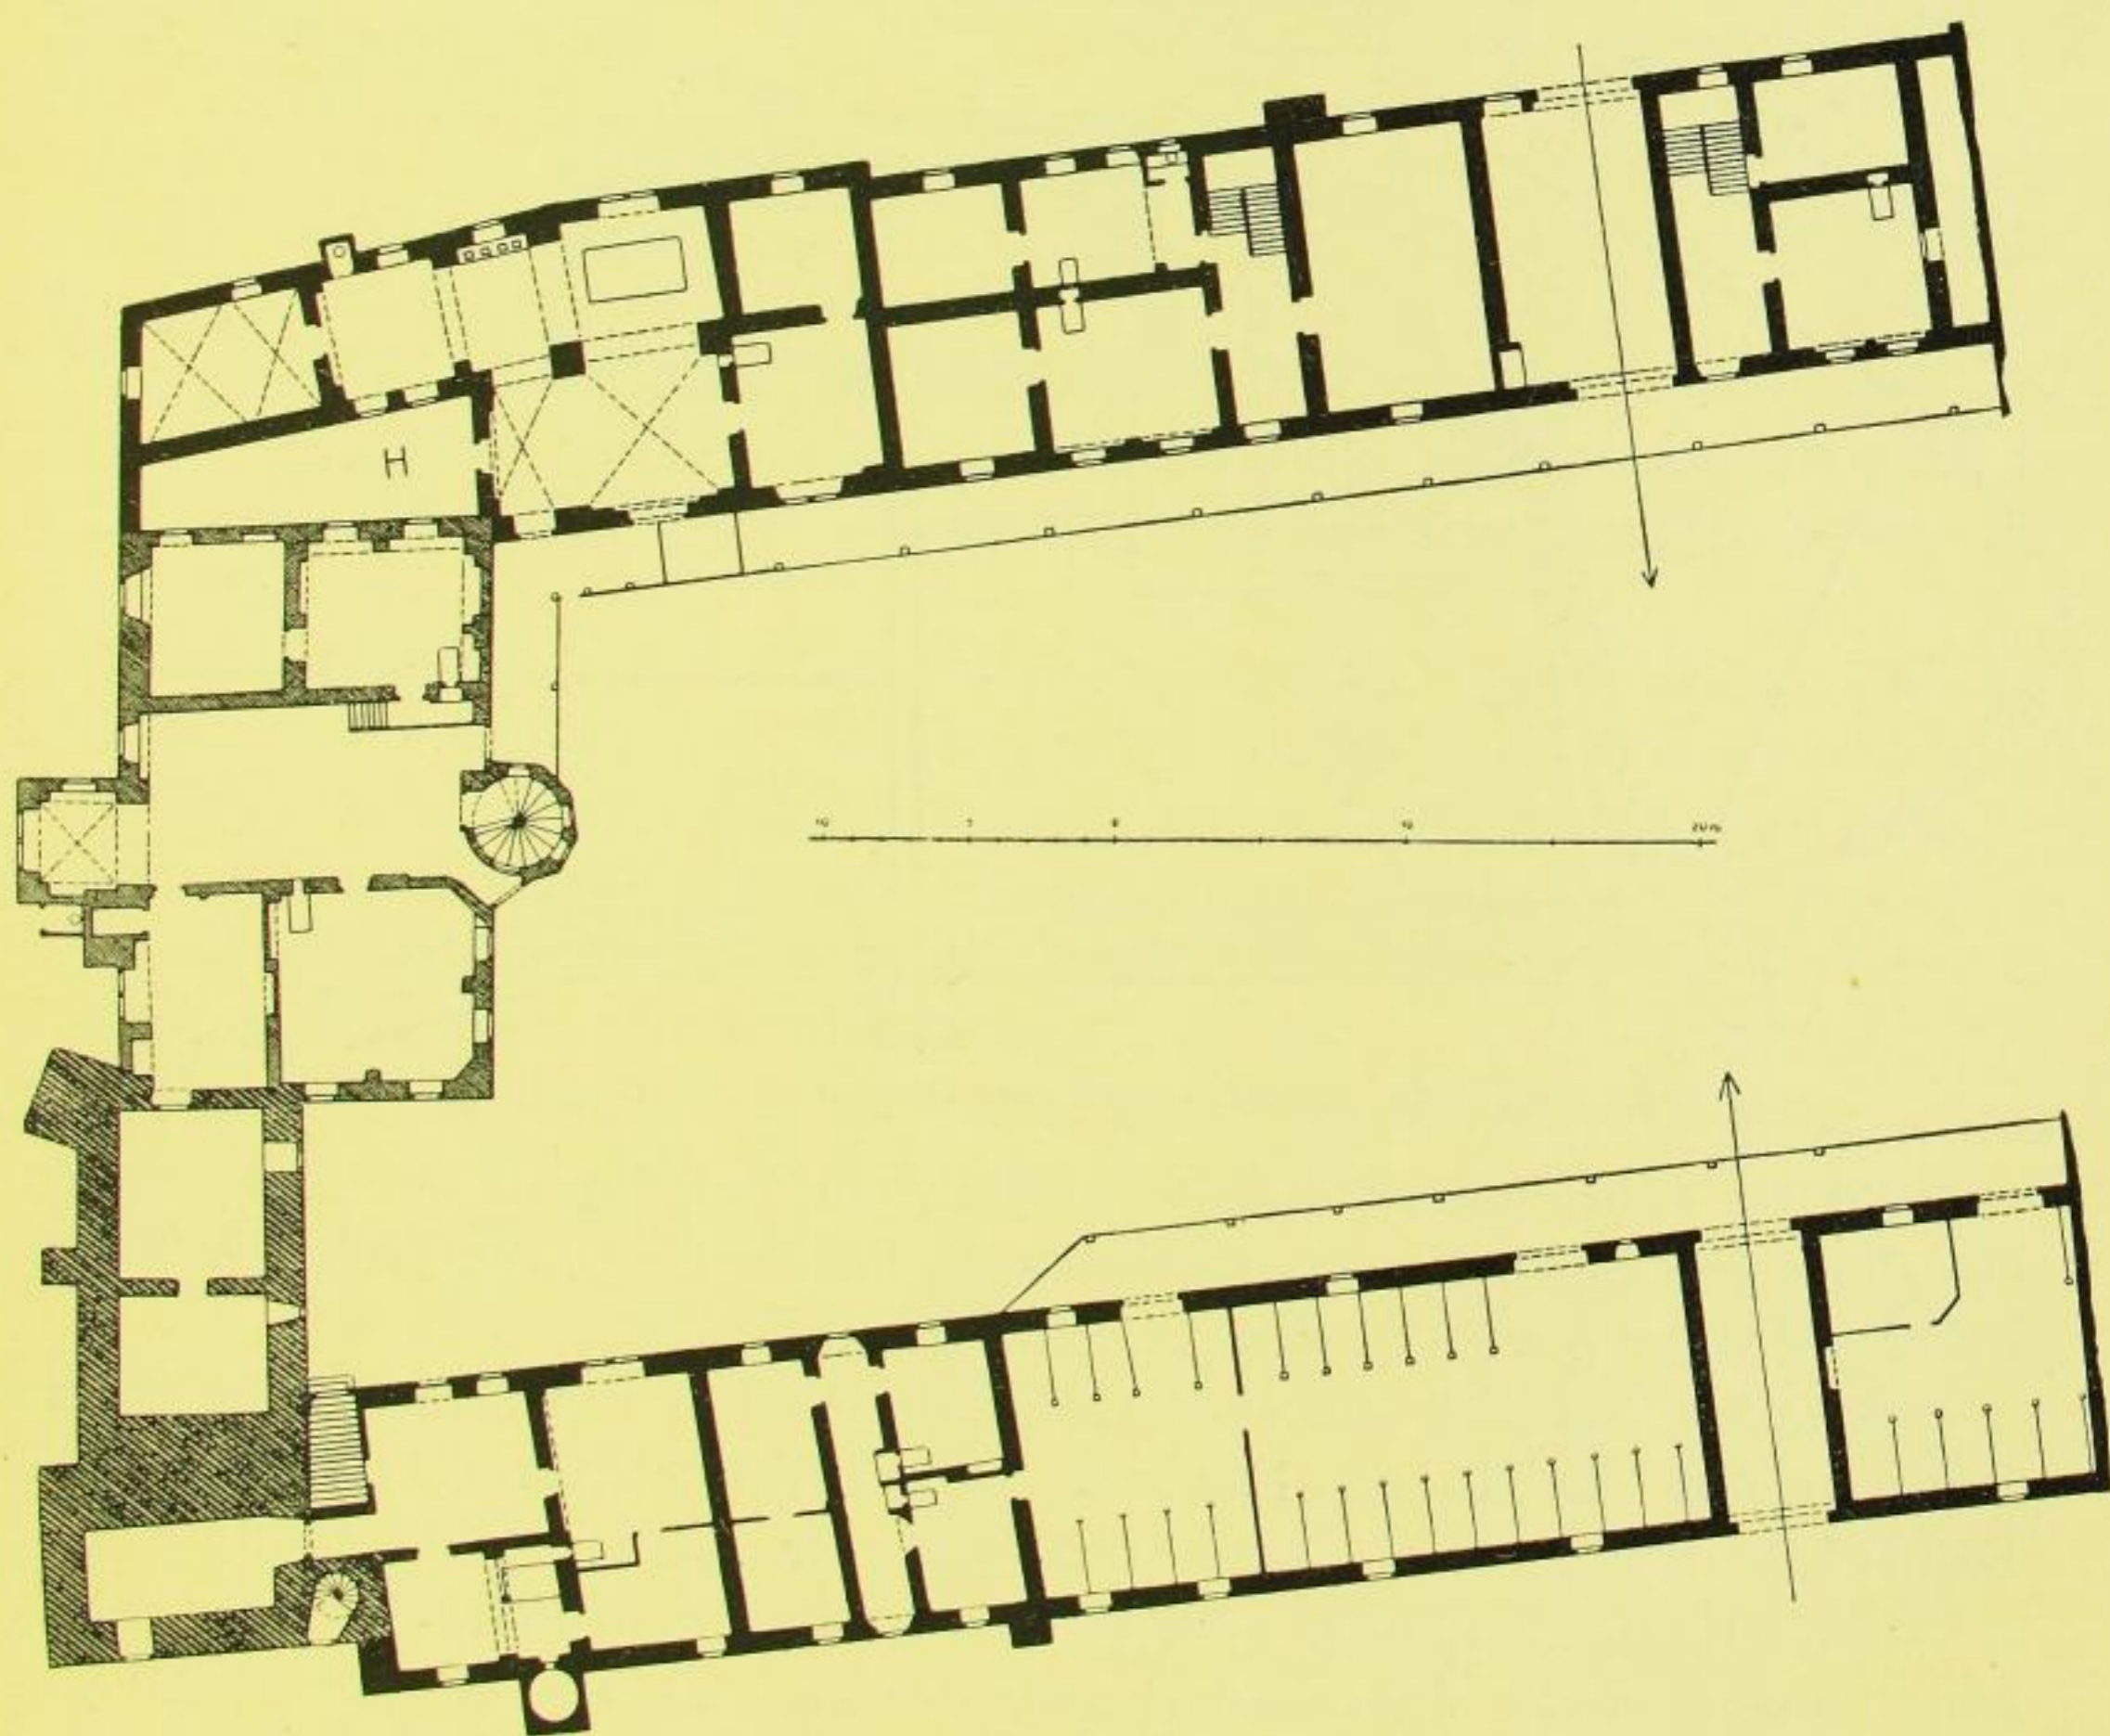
Kalkreuth, ehemaliges Schloß, Grundriß des Erdgeschosses.
